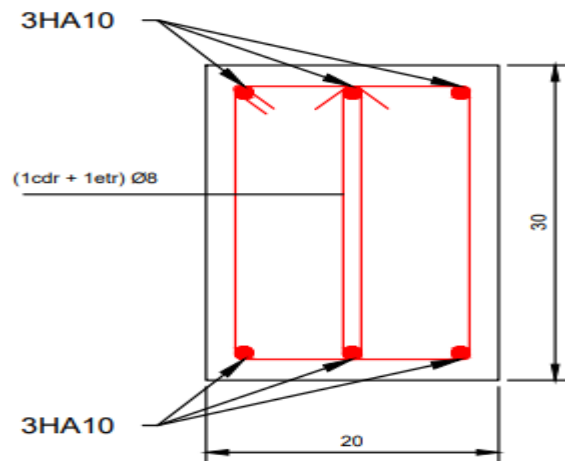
Schéma de ferrailage de la poutre de chaînage en travée et en appui
